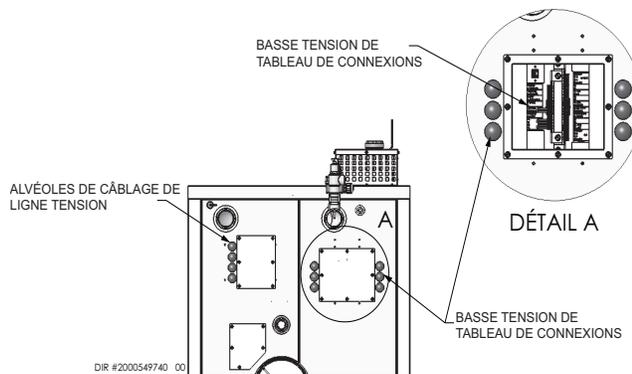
C Connexions du câblage de tension secteur de la appareil - 480V
